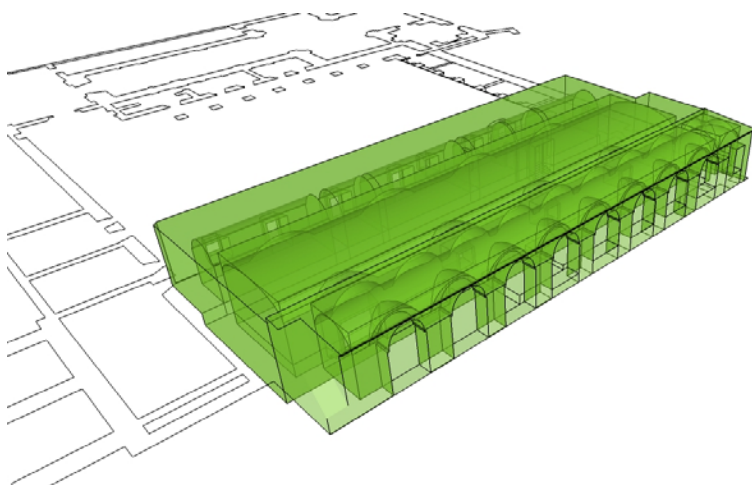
Reconstrucción Virtual Sector 3 a: Ala Norte Planta Baja. Vista desde la Huerta
